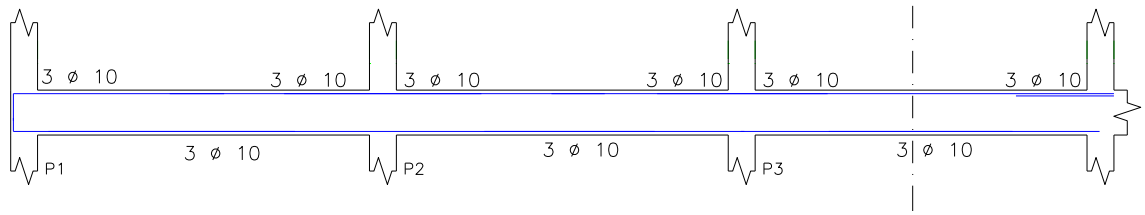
Esquema do dimensionamento à flexão das vigas finais 01/06/07/12, todos os pavimentos
